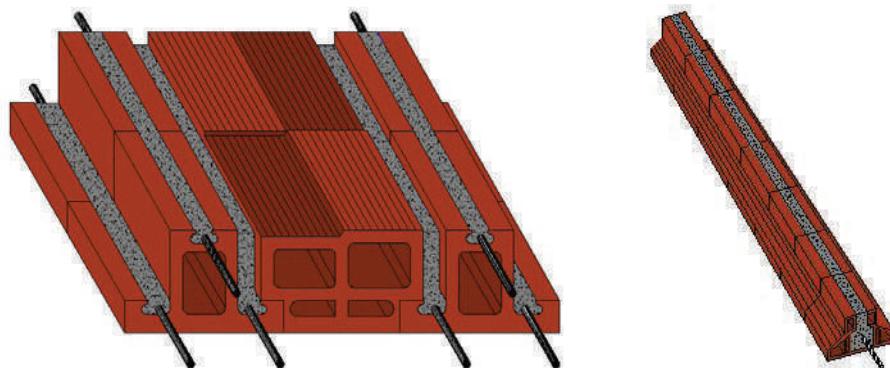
Laje Pré-moldada tradicional toda em cerâmica. (*-5).
